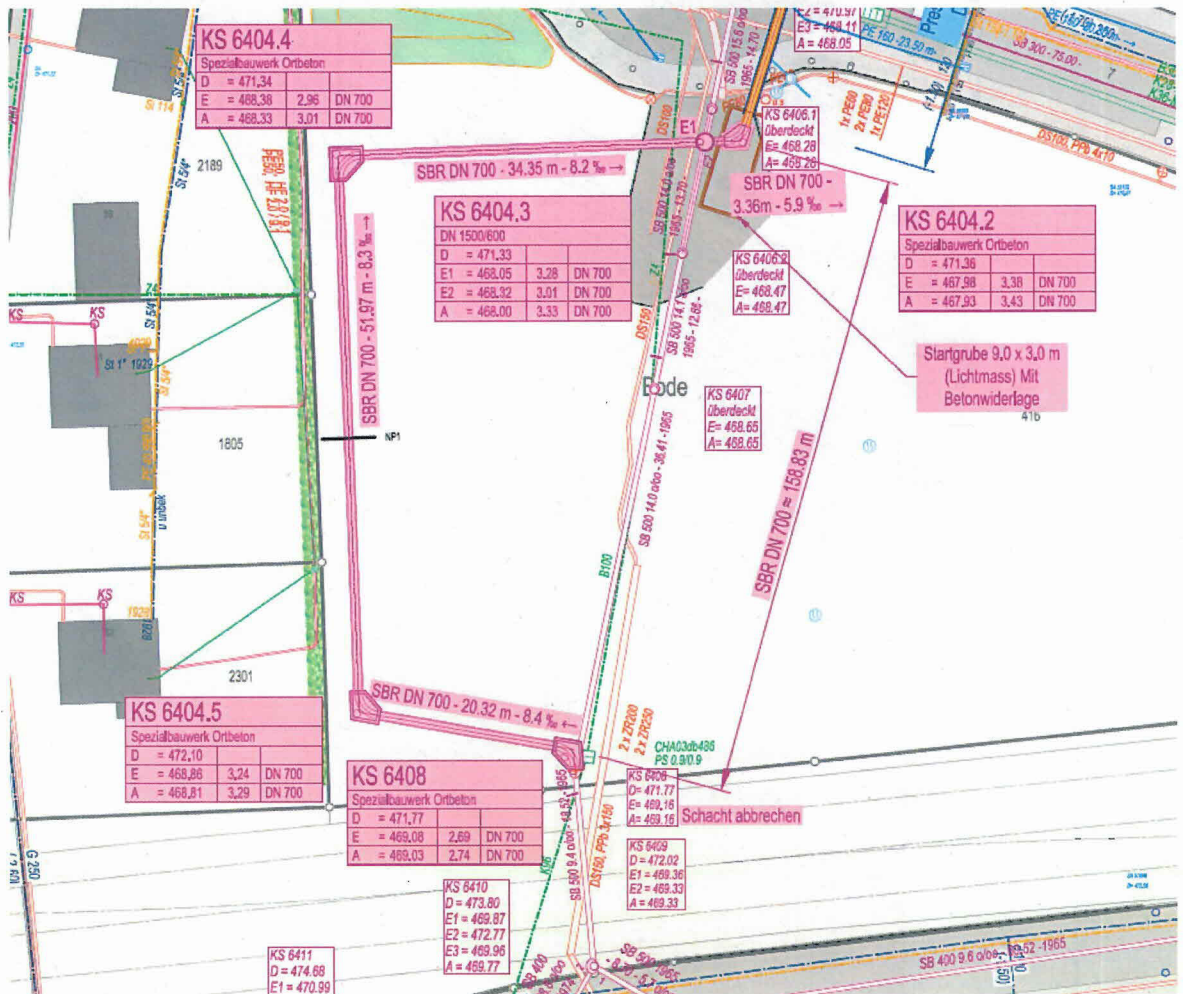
Ausschnitt Situationsplan Bauprojekt
